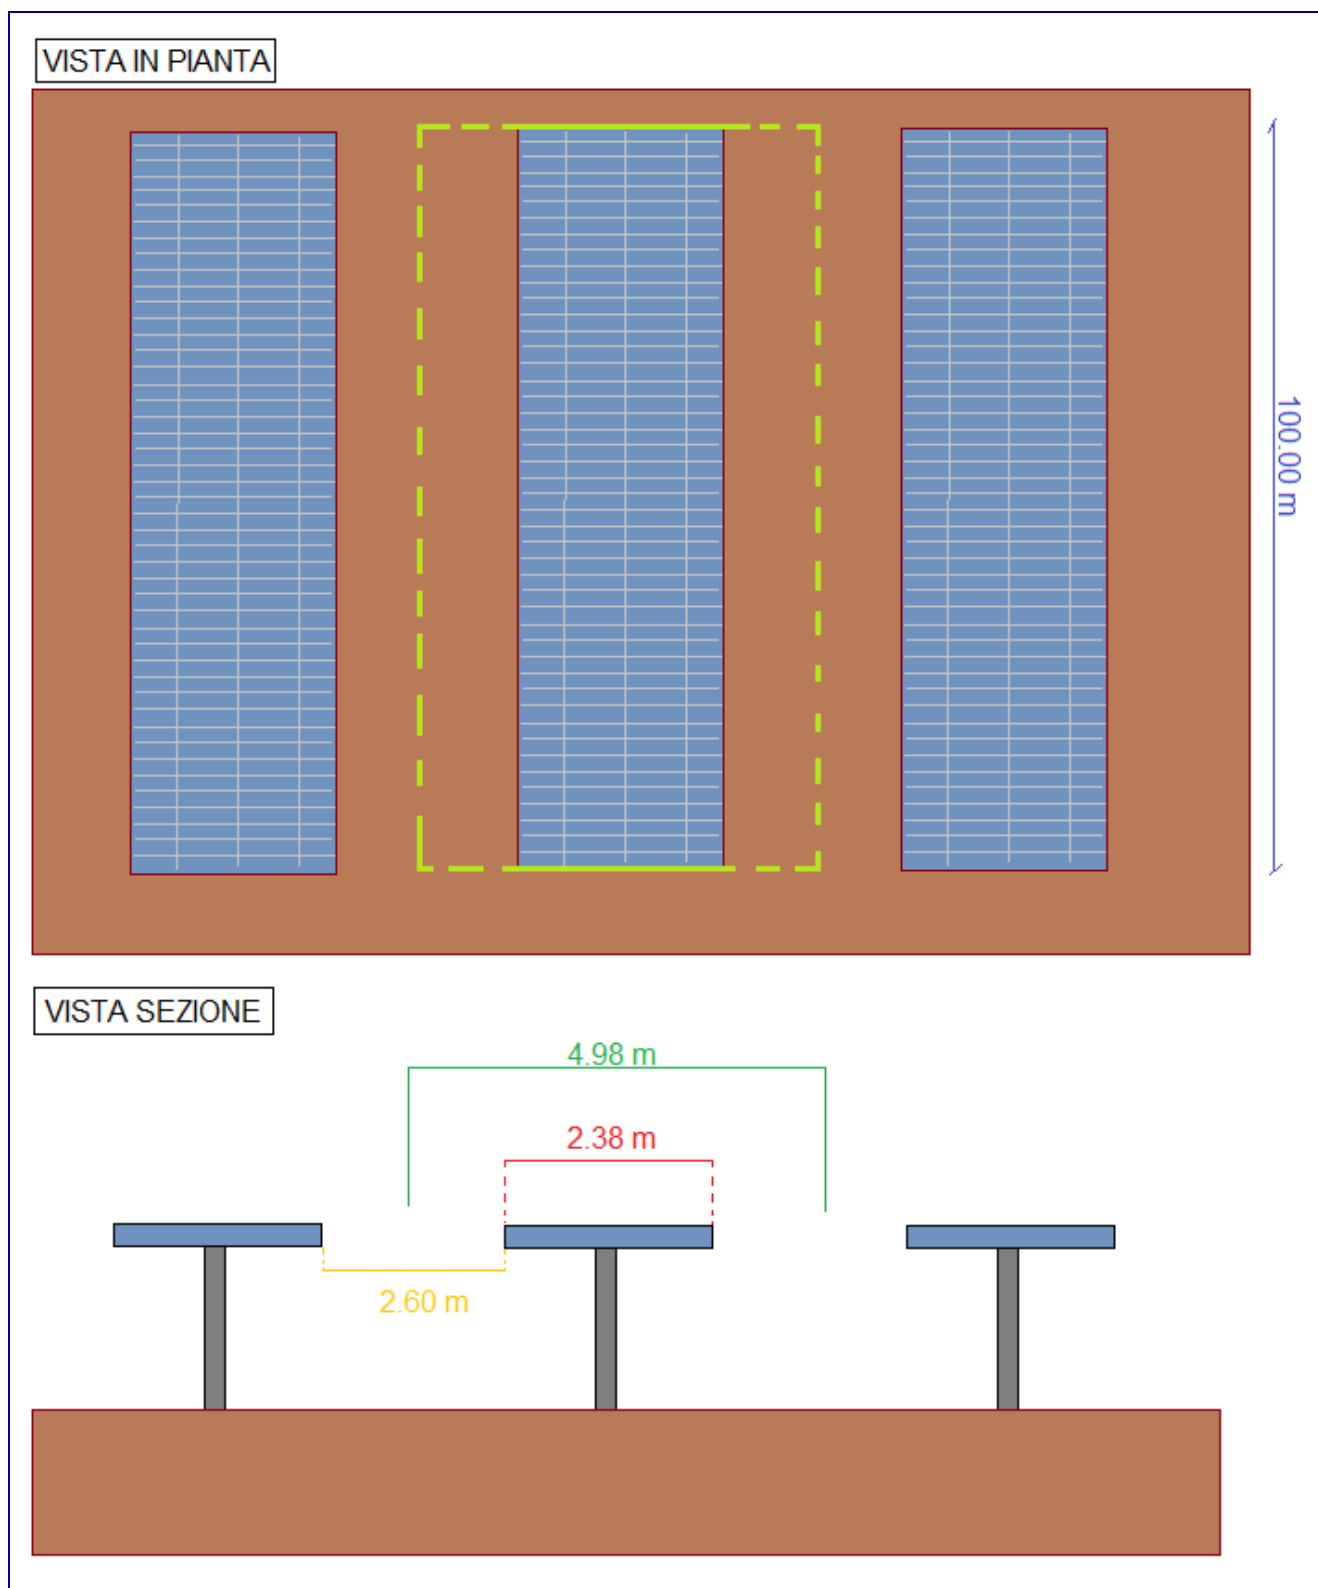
Vista planimetrica e sezione tipo posa in opera batterie pannelli fotovoltaici
